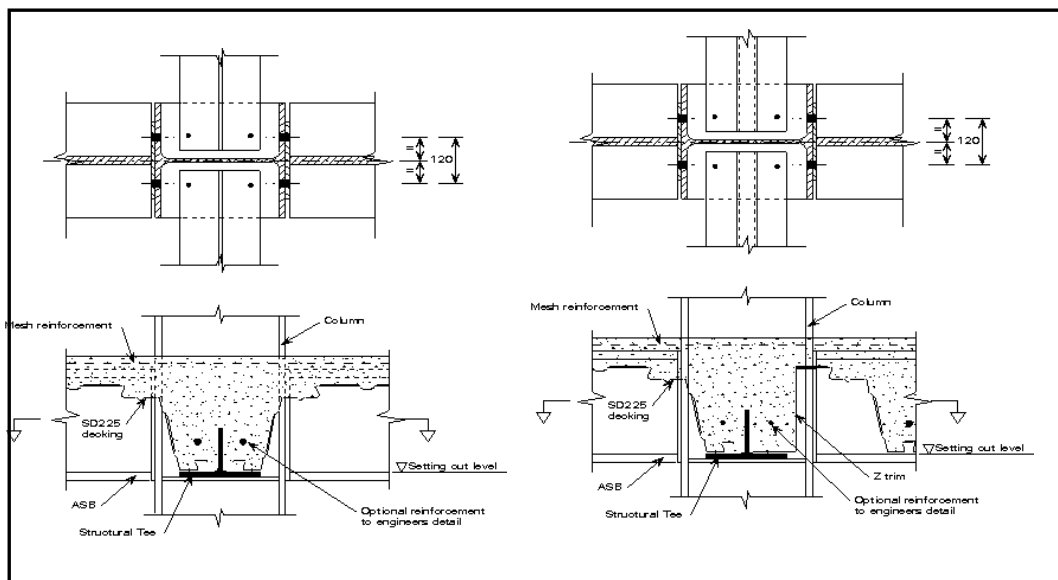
Detalhes construtivos para elementos de travamento de seção T invertido
